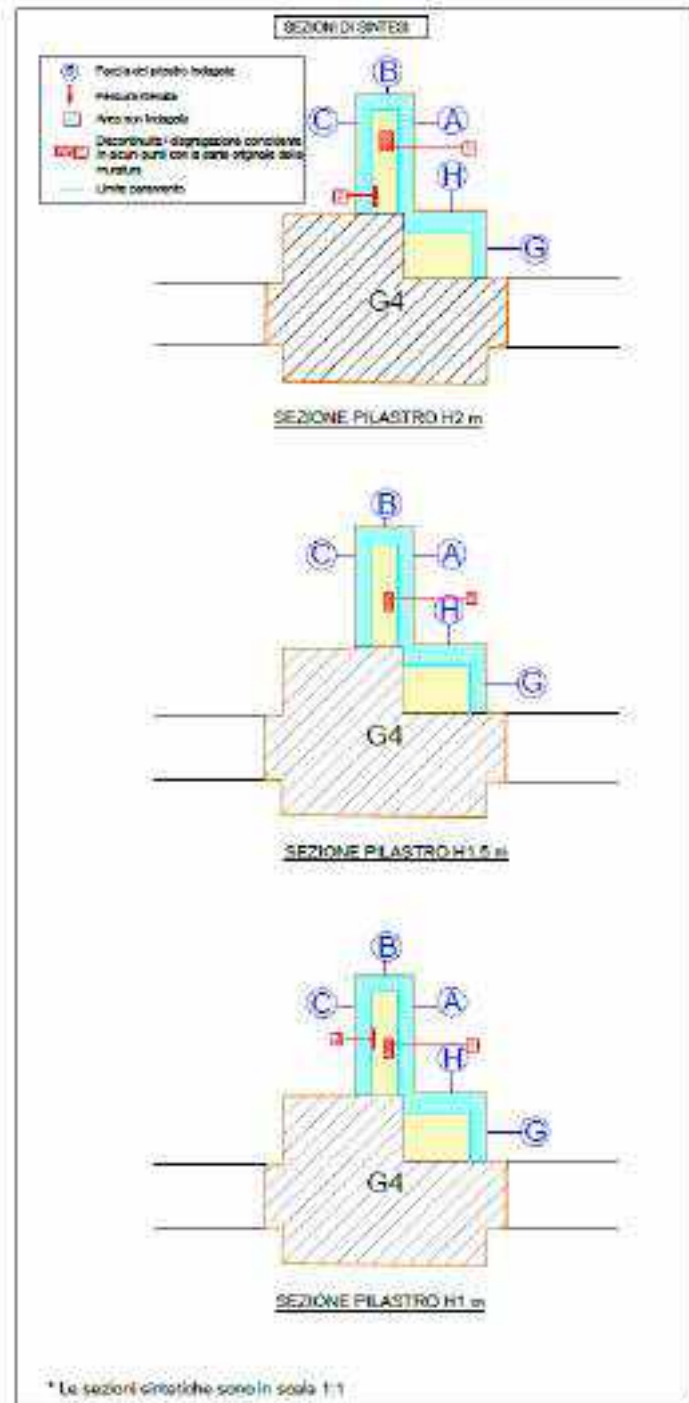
Planimetrie di sintesi del rilievo radar eseguito sulle zone accessibili del pilastro 4.
